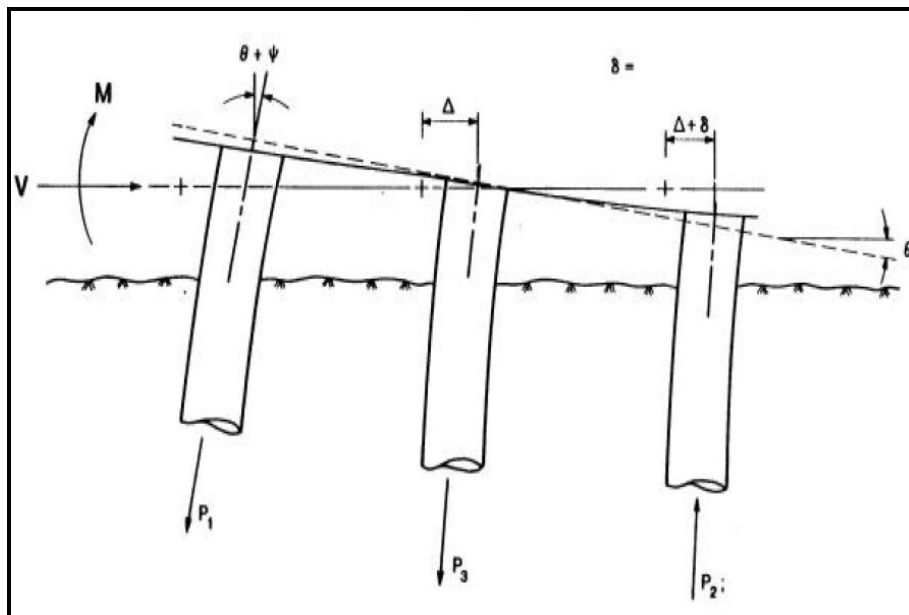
Comportement d'un groupe de pieux verticaux sous chargement transversal.
